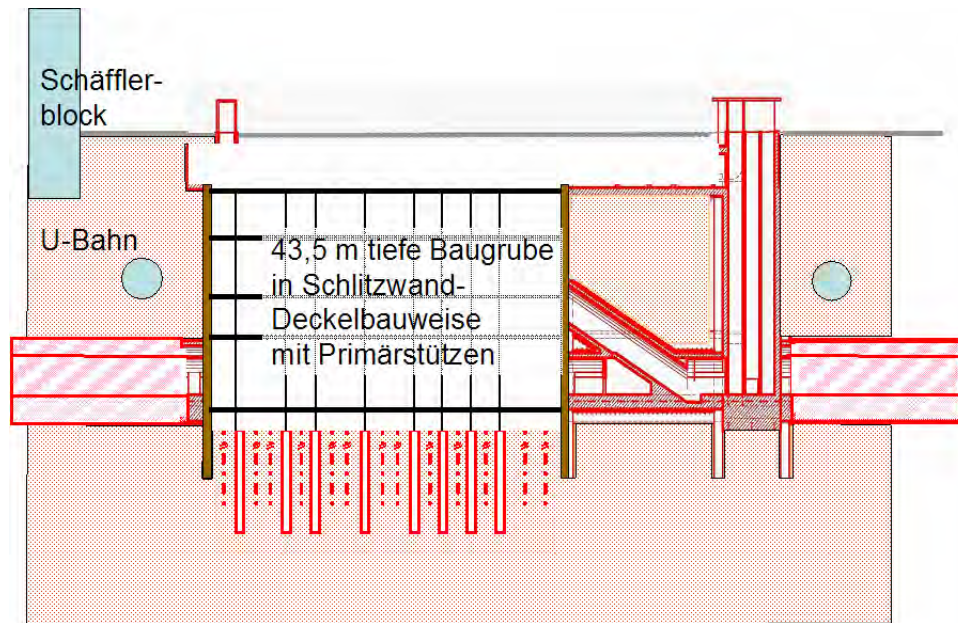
Längsschnitt durch das Bauwerk Haltepunkt Marienhof
